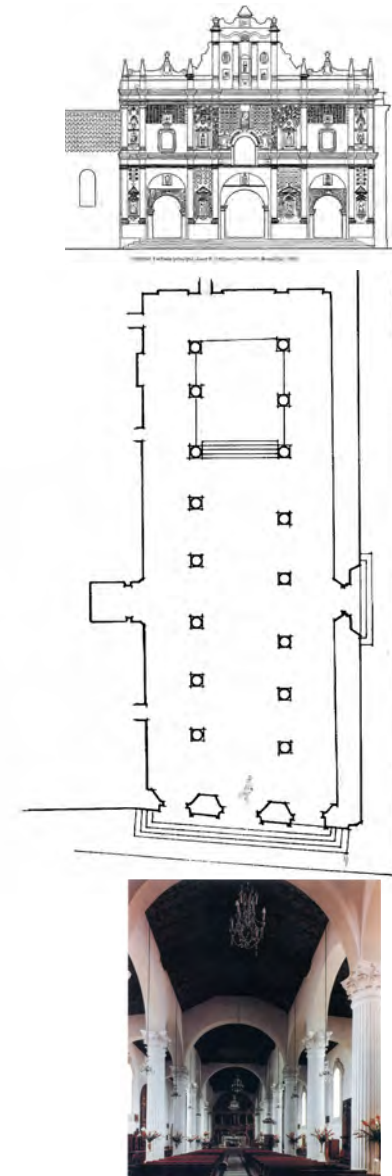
Planta general, alzado y vista interior de la Catedral de San Cristóbal de Las Casas.
